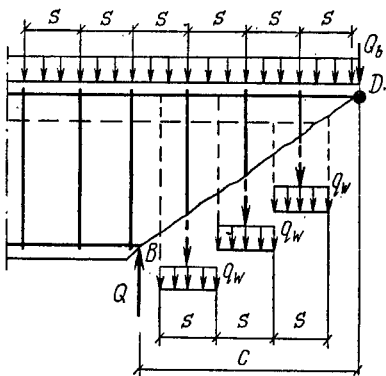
Усилия в поперечных стержнях, принимаемые при расчете балки по наклонным сечениям
